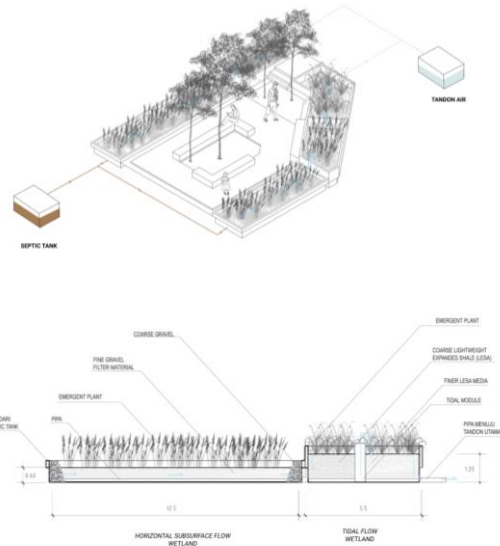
13. Potongan skema aliran air hujan dalam bangunan
